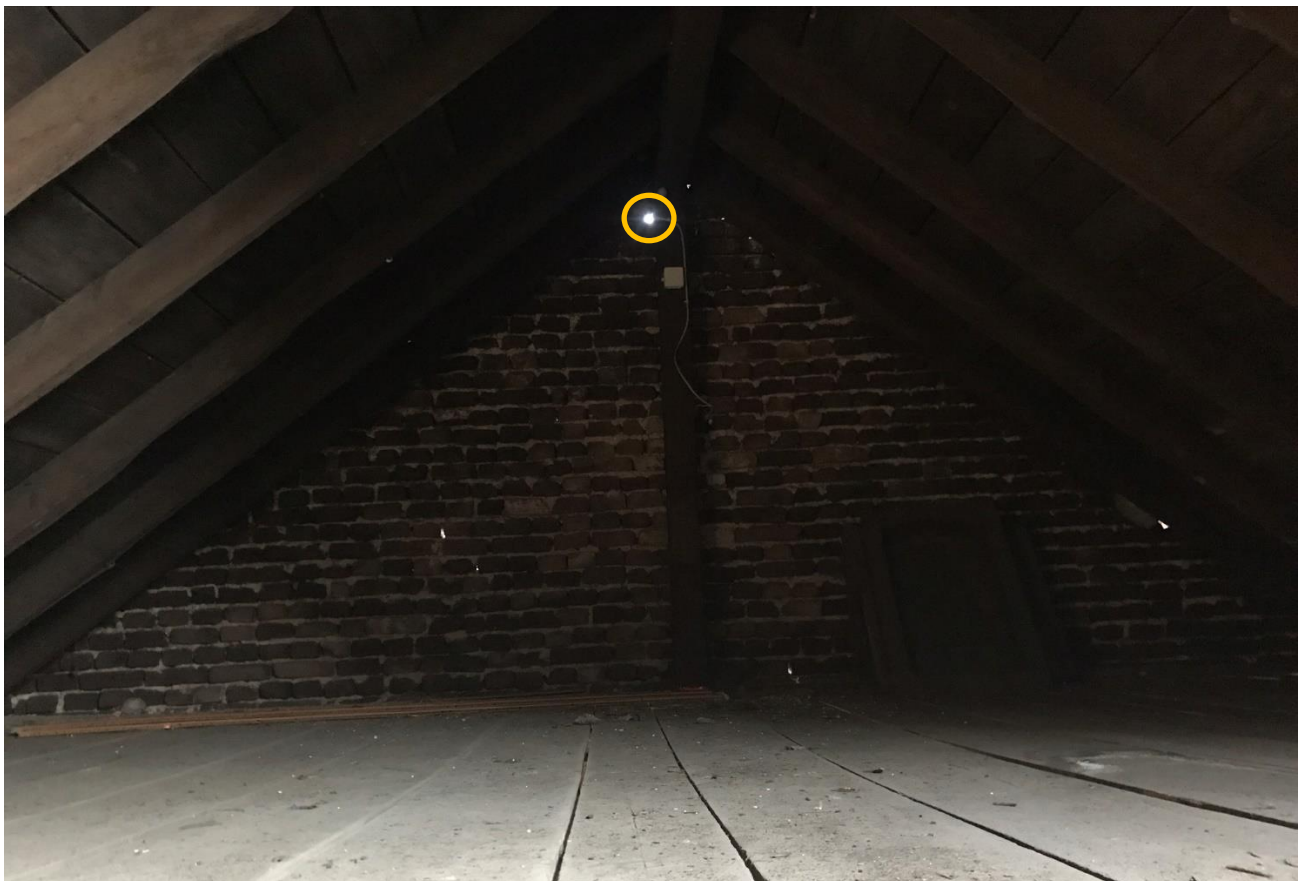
Mehrere kleine Löcher sowie ein größeres Loch in der Fassade im Bereich des Dachbodens.
